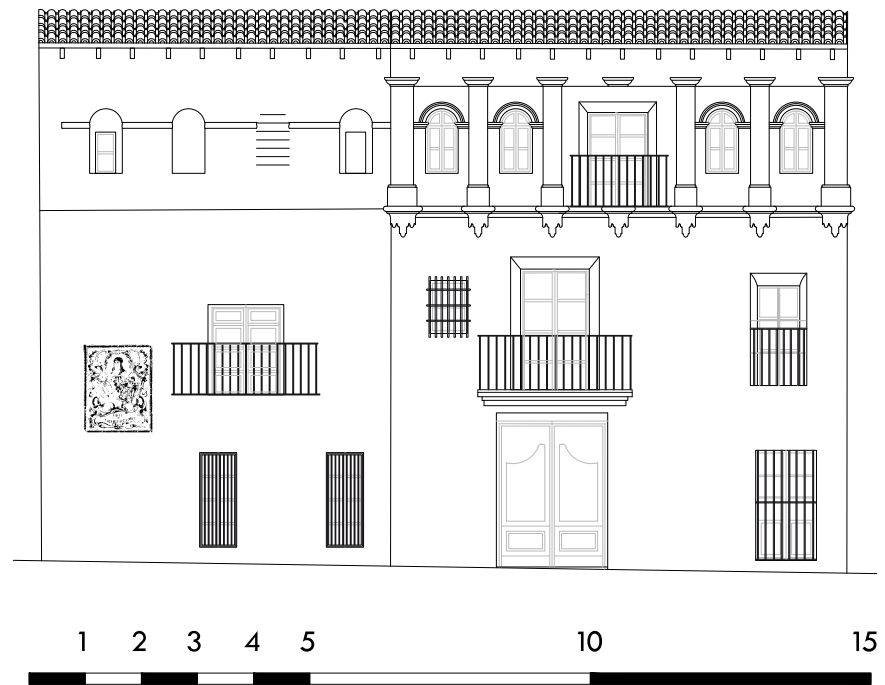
Fachadas de las casas 1 y 2 de la calle Pouets.
